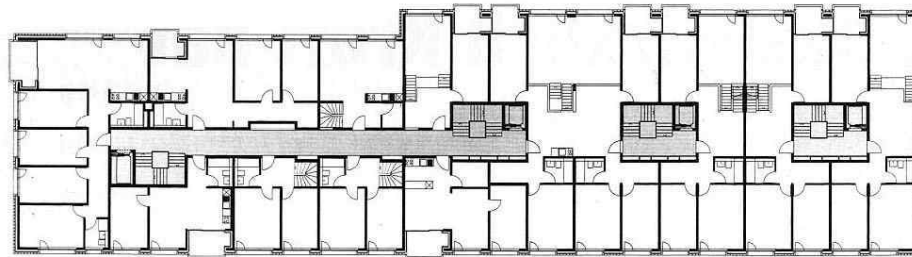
Grundrisse Haus A, 1. bis 3. Obergeschoss
